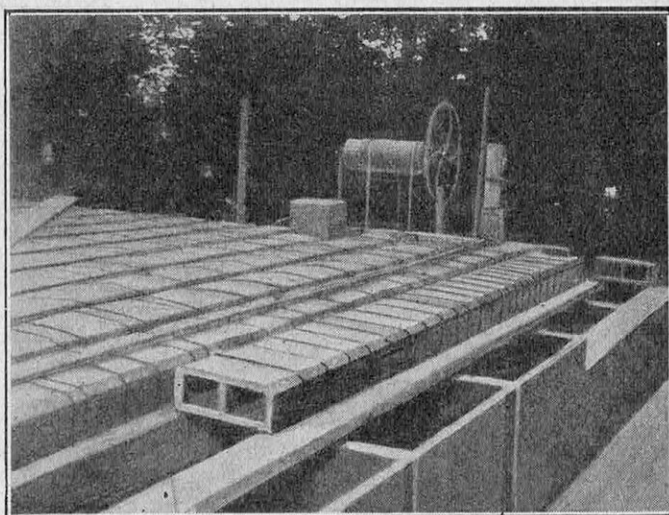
PLANCHER EN BÉTON ARMÉ EN COURS DE CONSTRUCTION
